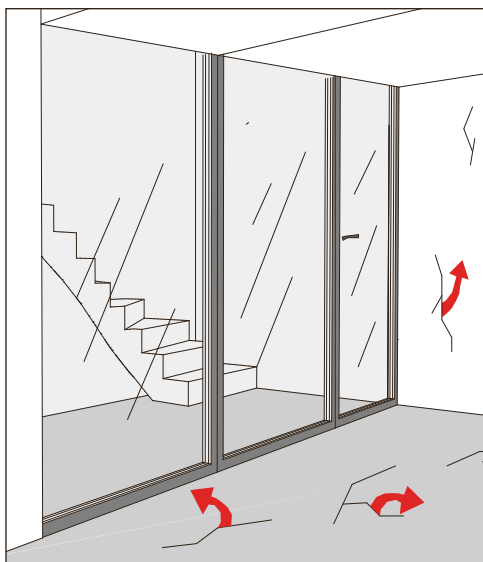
Divisione del locale con l'aiuto di una parete impermeabile ai gas (Fonte: SMUL).
